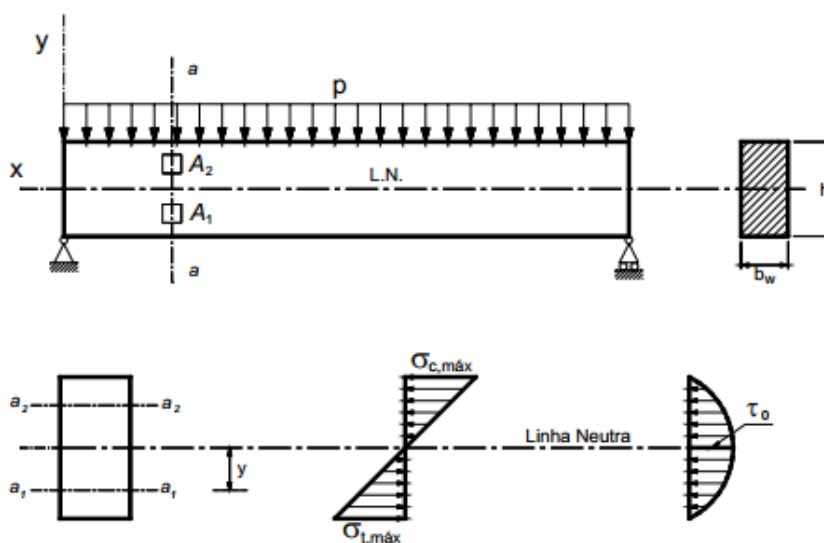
Viga sob efeito de carregamento vertical distribuído
